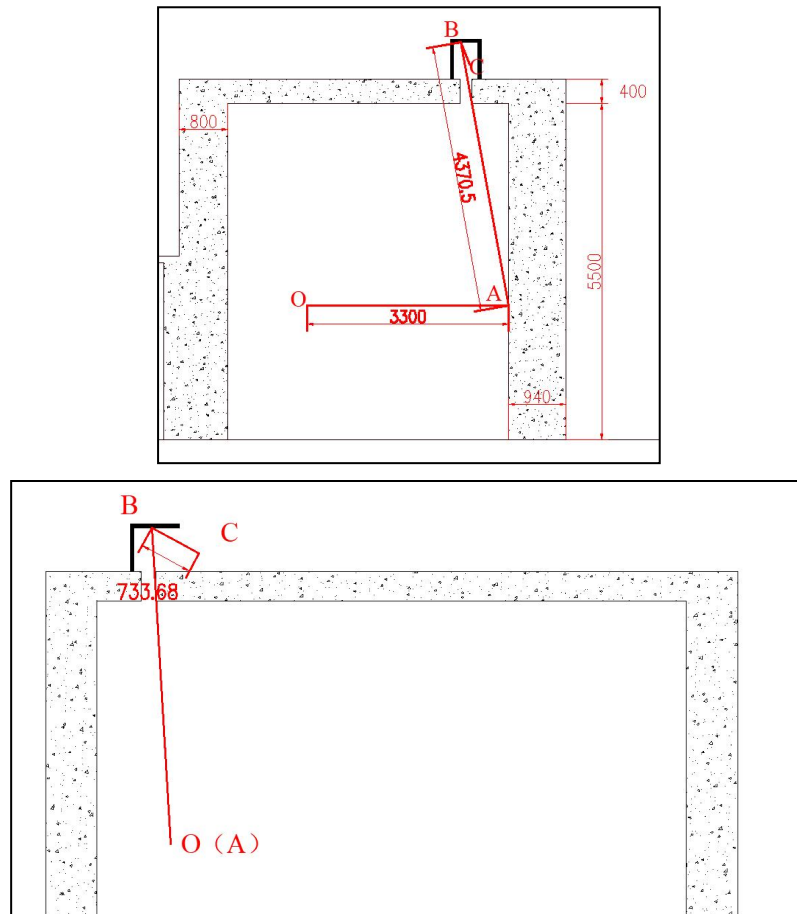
本项目探伤房曝光室通风管道散射示意图（单位：mm）
